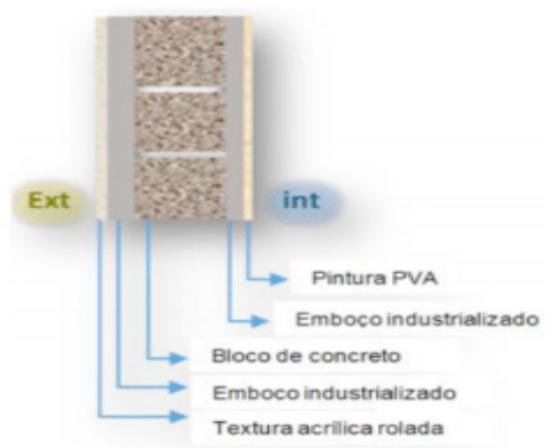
Sistema construtivo do apartamento do estudo de caso 2.
